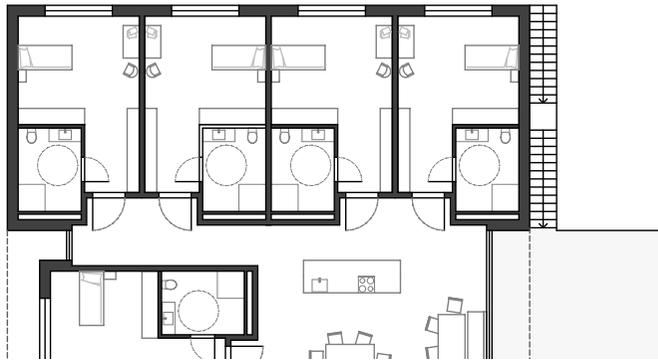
Grundriss nördlich ausgerichtete Zimmer
